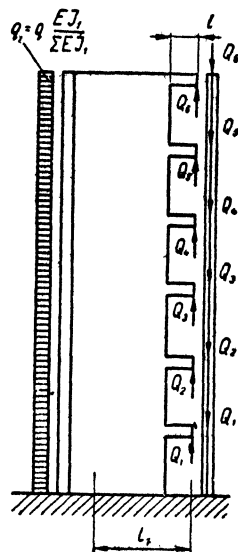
Схема нагрузок на ветви диафрагмы, примыкающей к продольной стене.
